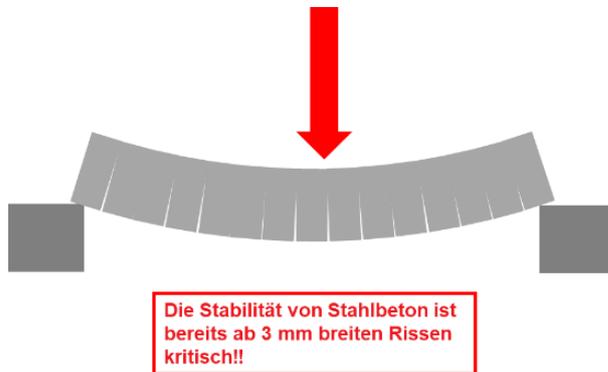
Risse in einer Decke aus Stahlbeton
